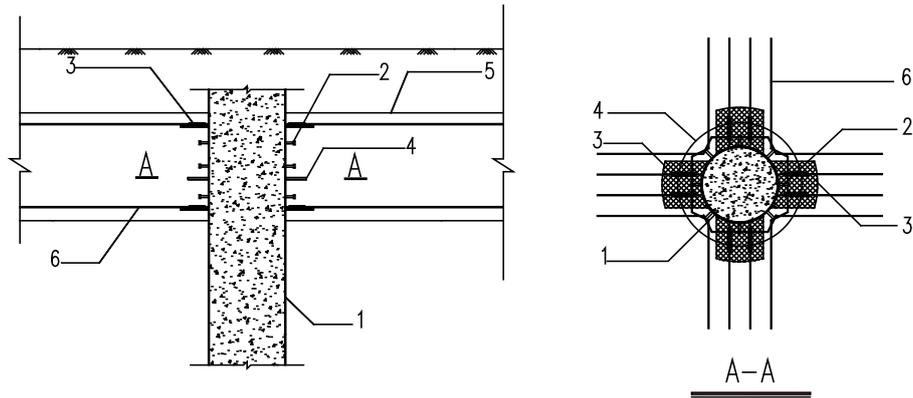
钢管混凝土柱与底板连接节点示意图
